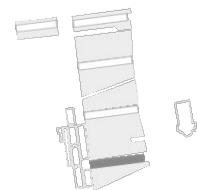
Lageplan Areal der Johann-Böhm-Wohnhausanlage M 1:5.000
